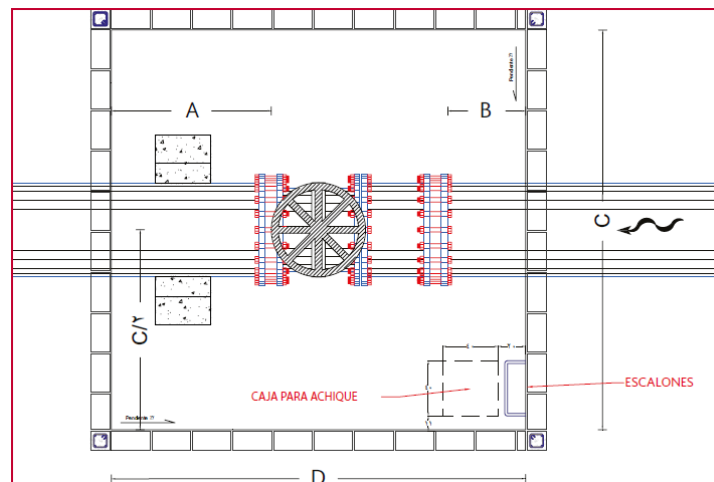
Caja de Válvulas (Vista en Planta).
